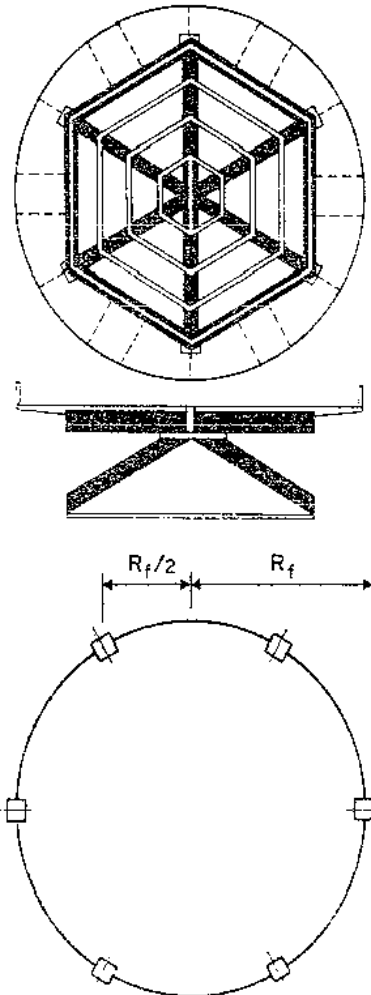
Estructura metálica para soporte de estanque elevado.
